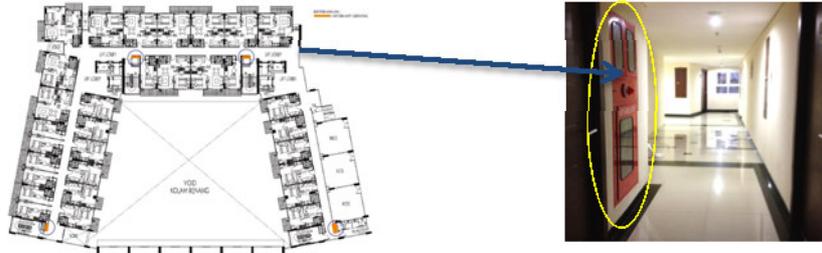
Lokasi Penempatan Tanda EXIT (kiri) dan Letak Rambu pada Denah Tower Apartemen (kanan)
